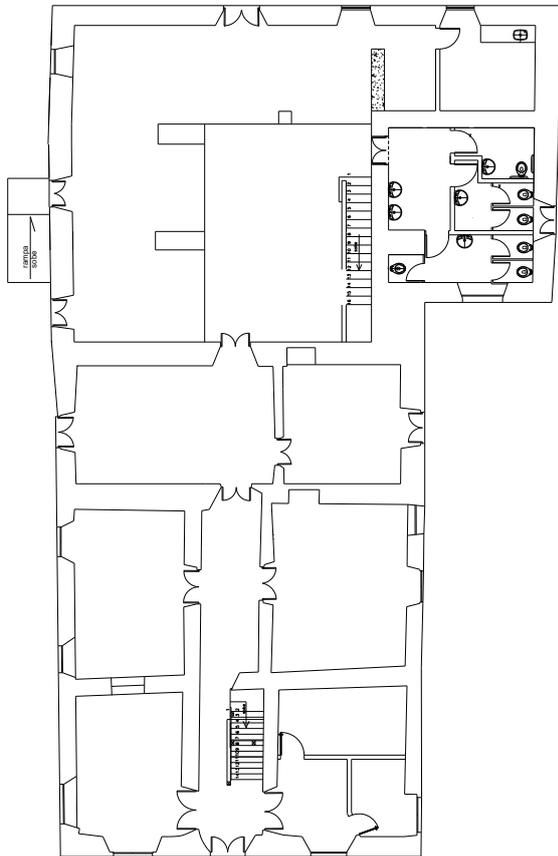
Planta Baixa Pavimento Térreo após intervenção no ano de 2006
